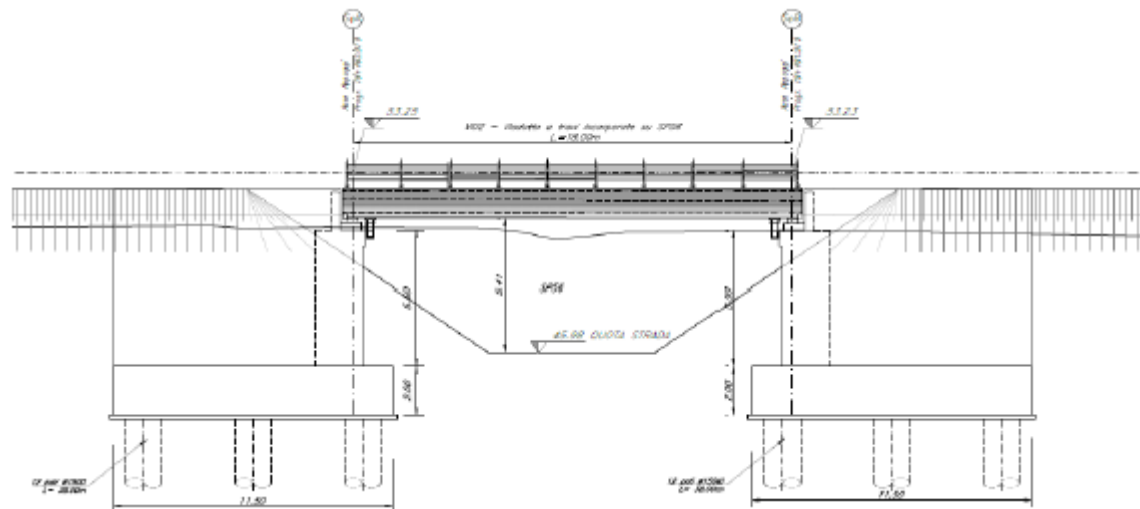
Prospetto/sezione longitudinale del viadotto VI02
